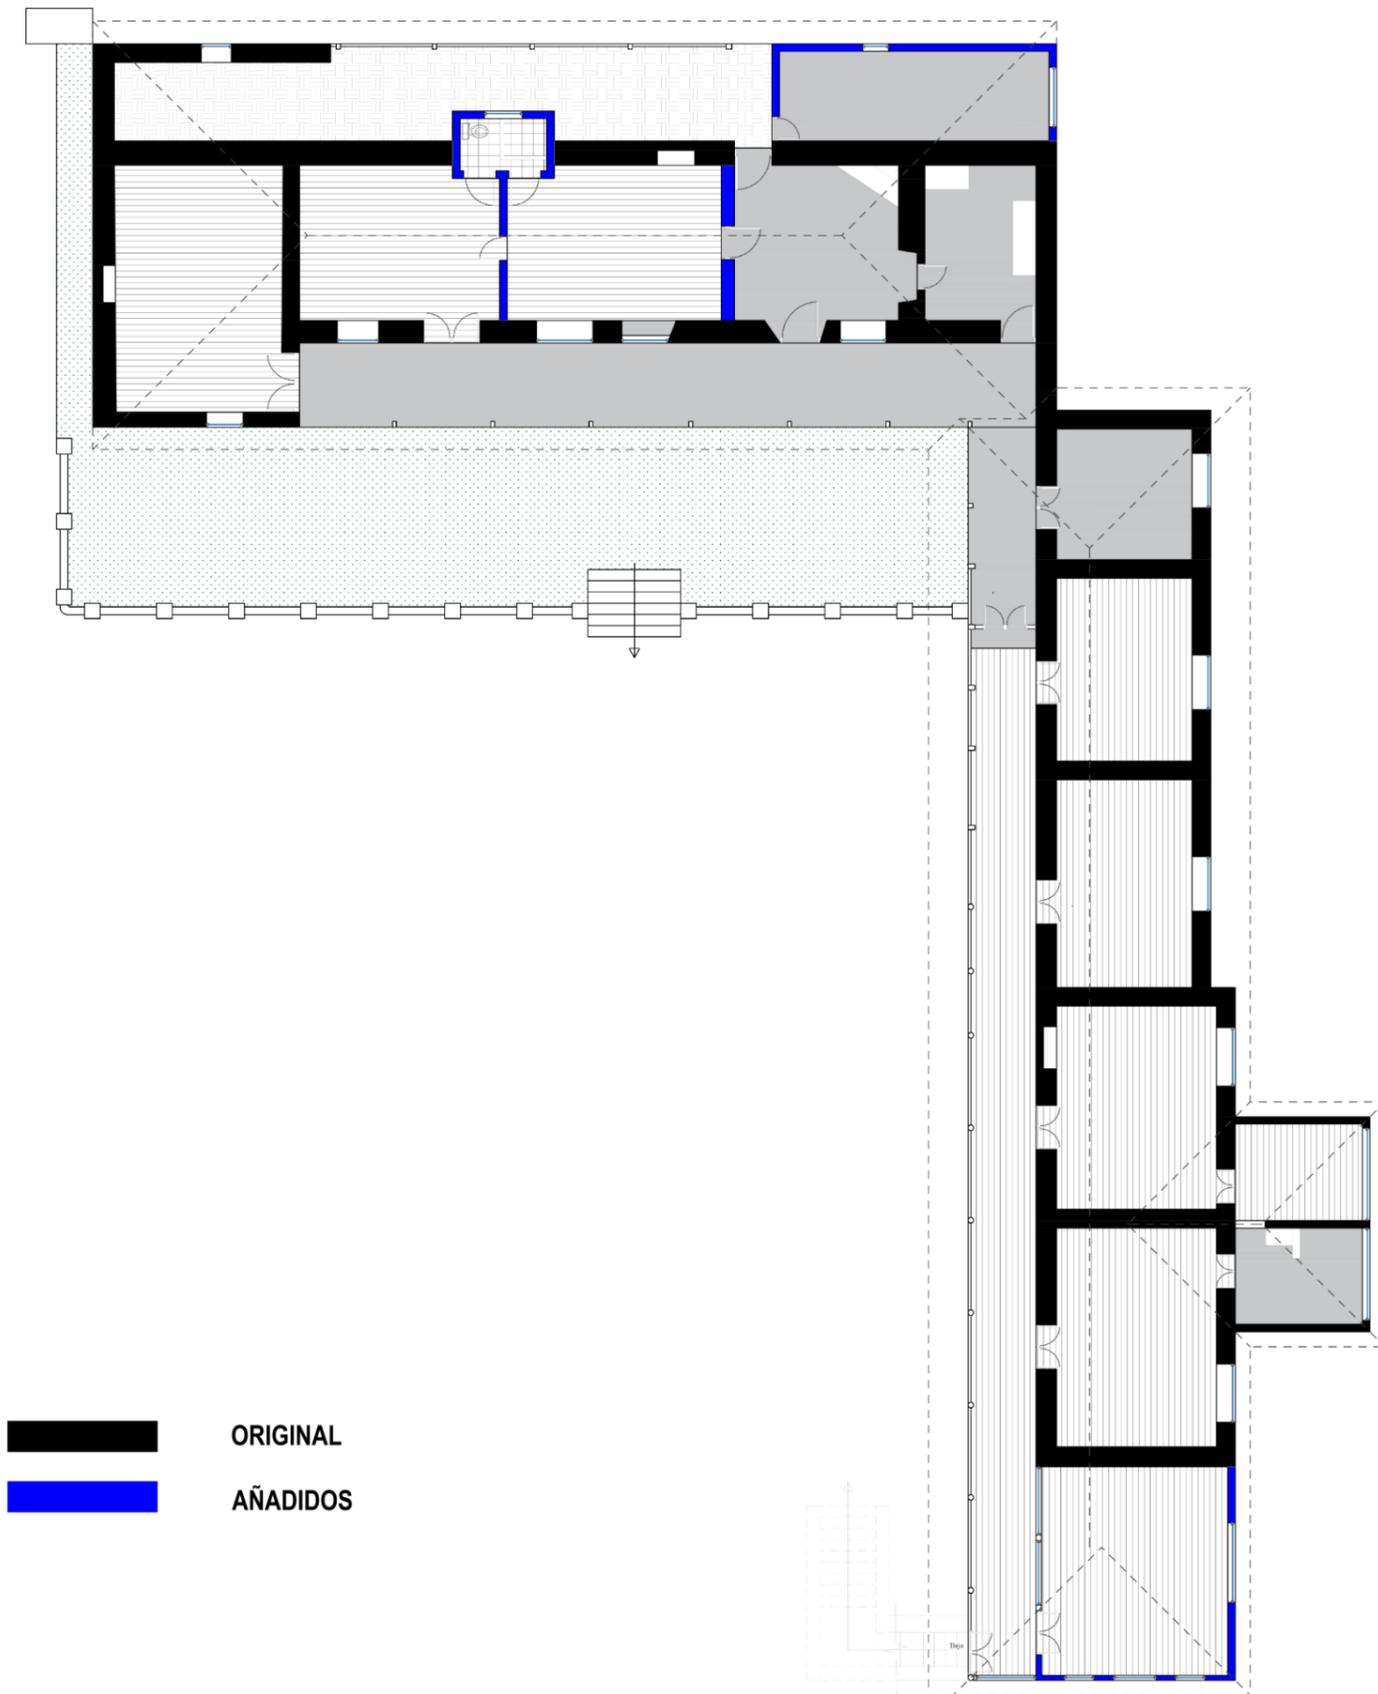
Planta Baja Bloque 1 y 2 Elementos añadidos Fuente Luis Segovia 2023
